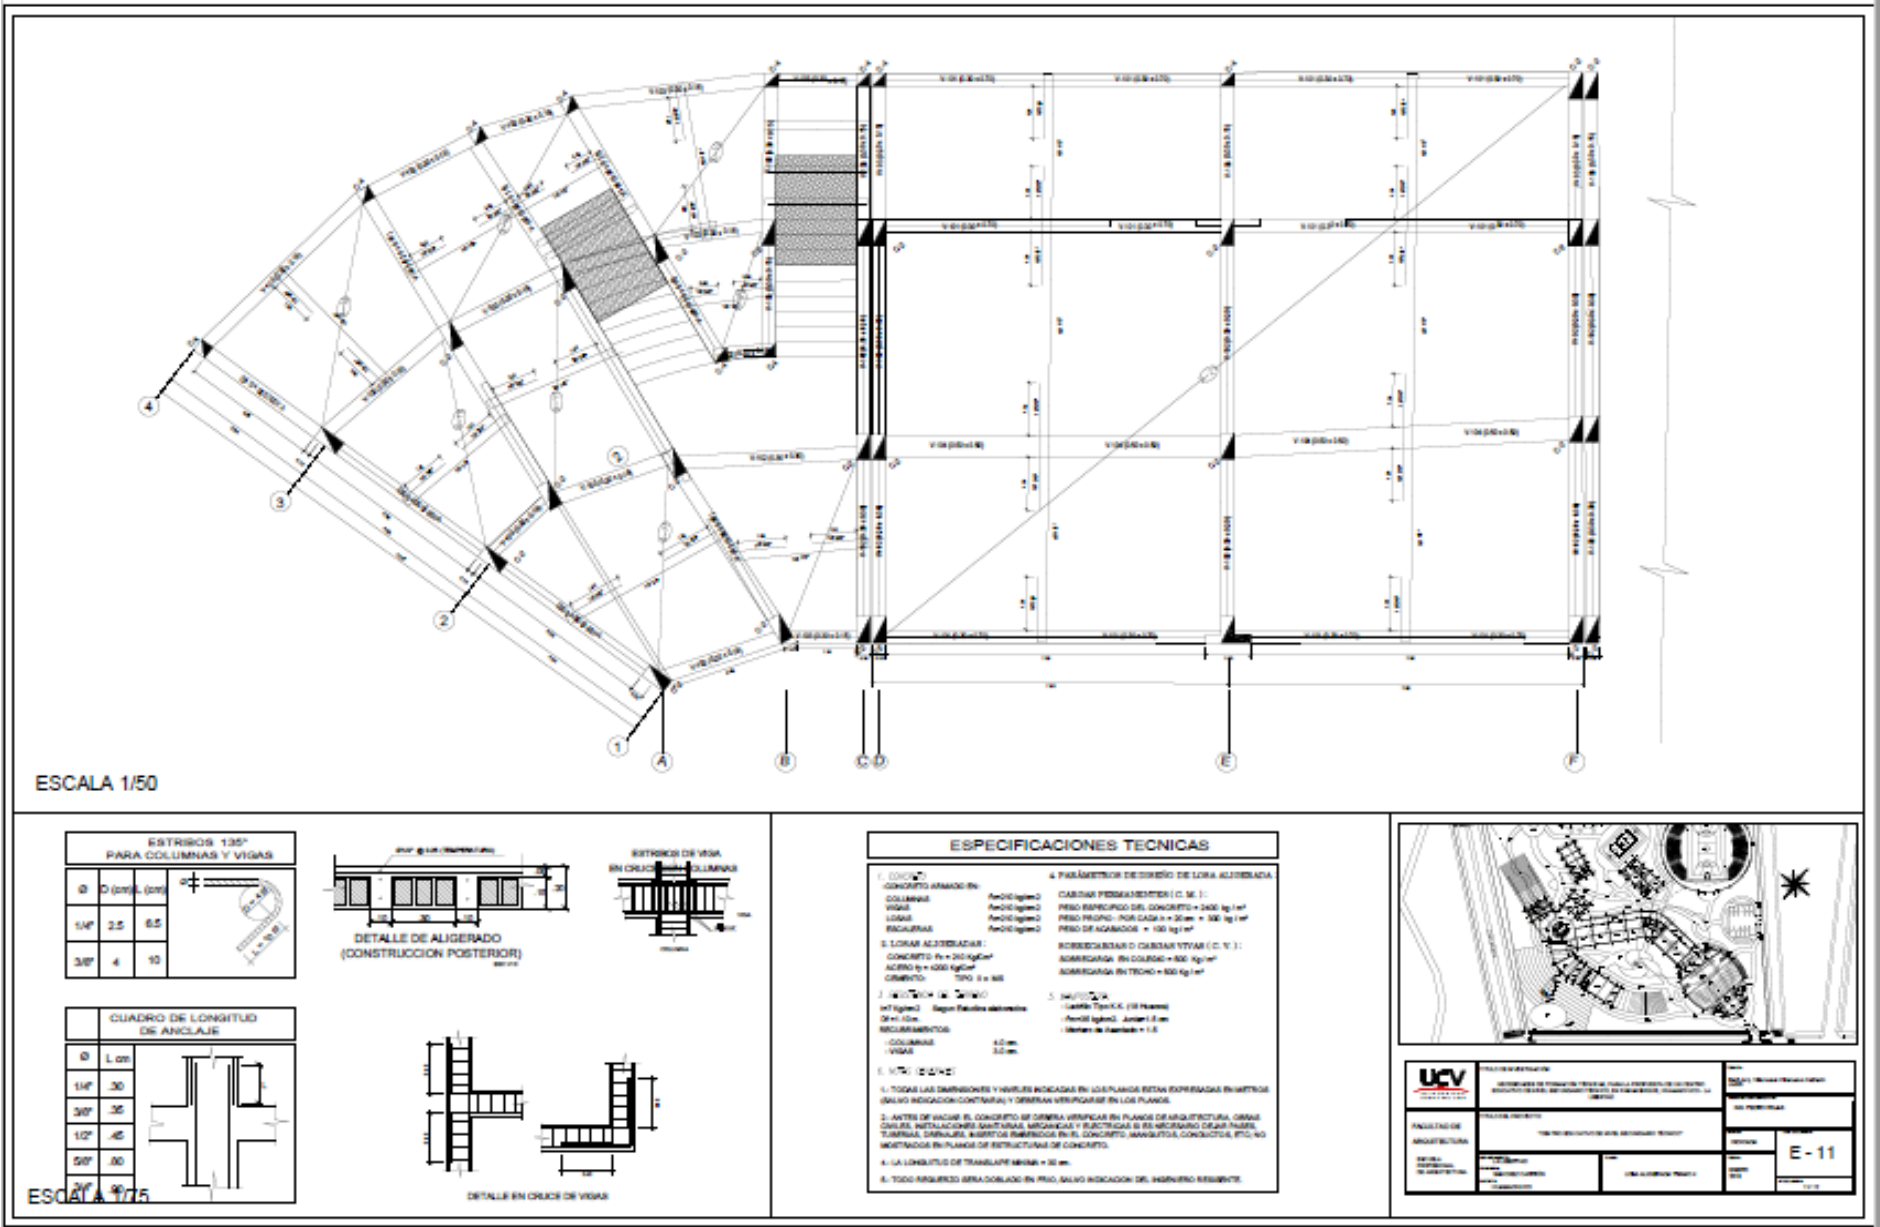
Plano Diseño Estructural Bloque 04 – Losa Aligerada - Plano N° 19 - Lamina E-11
